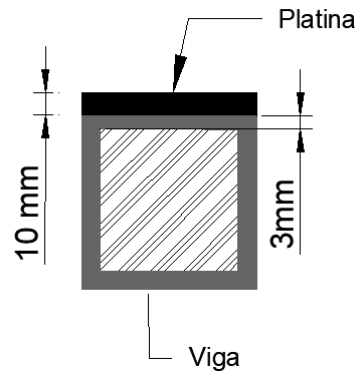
Platina adherida con soldadura a la viga
